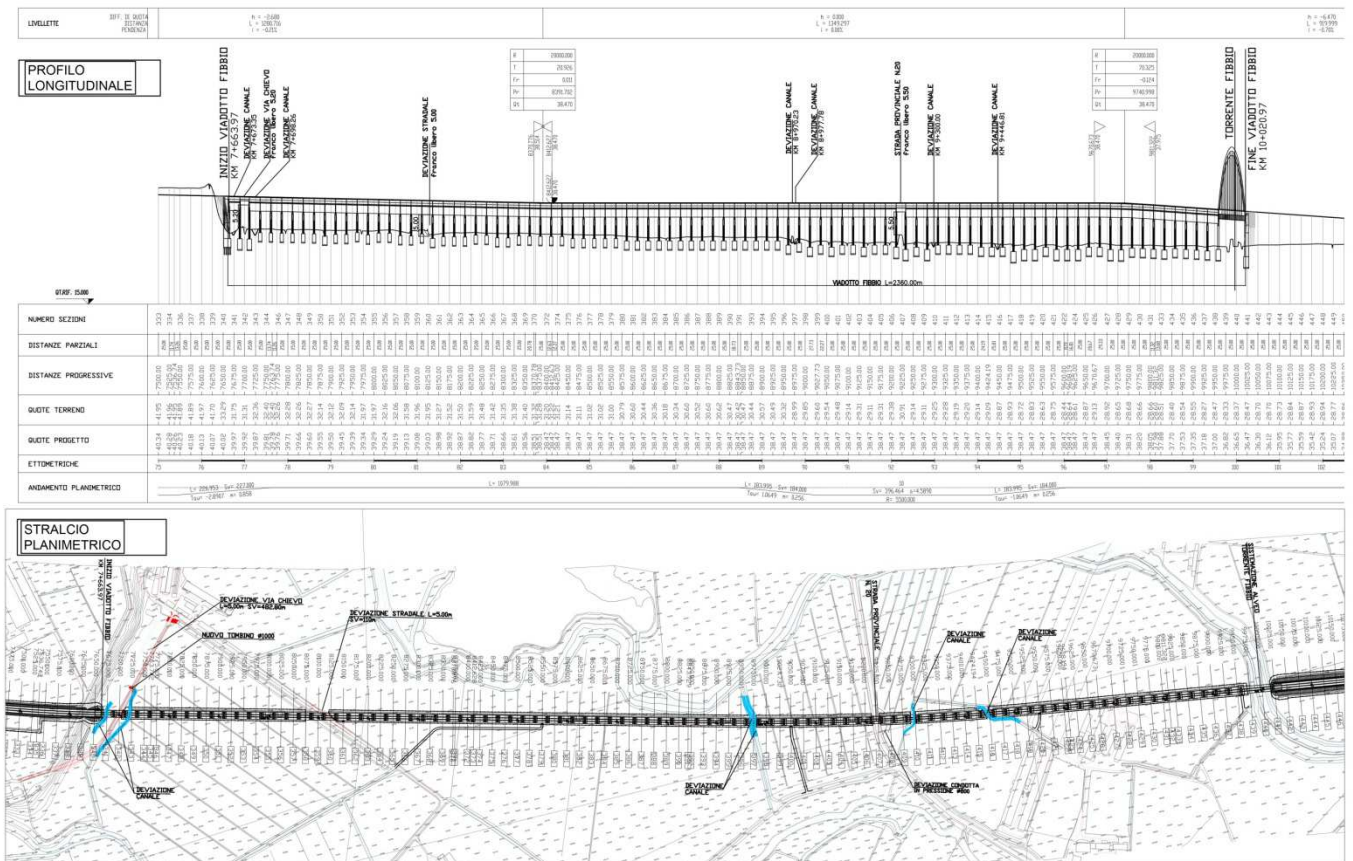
Planimetria e Profilo longitudinale dal km 7+500.00 al km 10+100.00 circa (Viadotto Fabbio)
